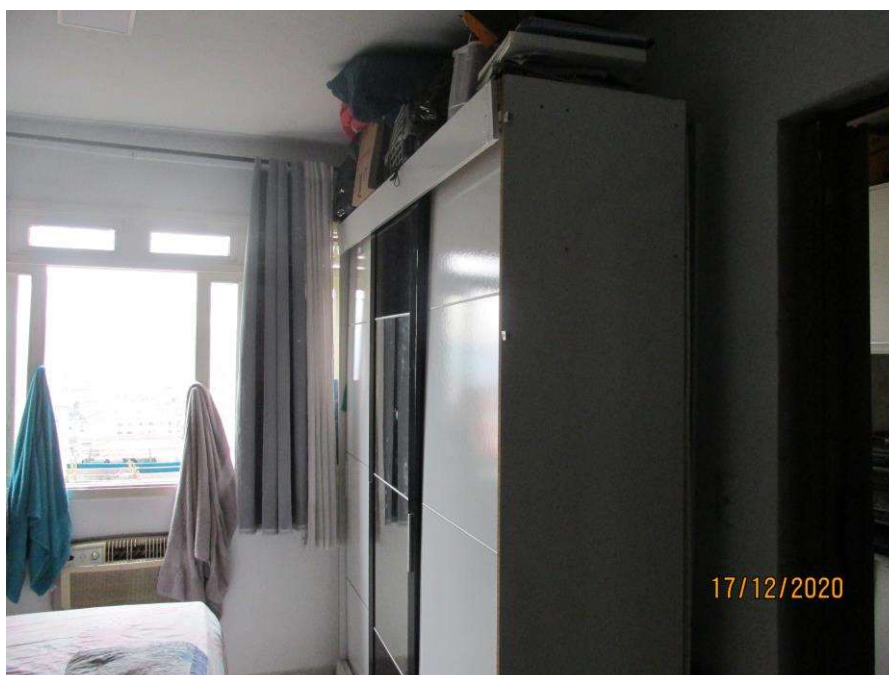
Outra vista do dormitório, com a janela voltada para a via pública – Av. Presidente Wilson
